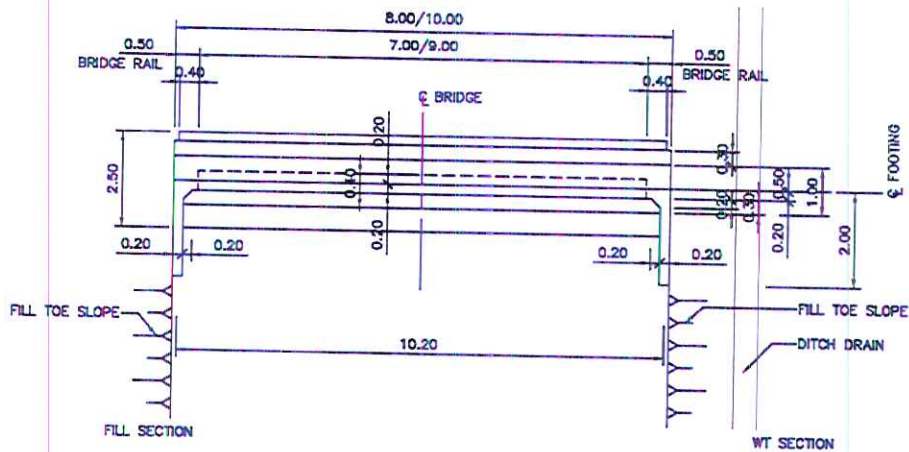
รูปตัดสะพาน PIER SECTION
